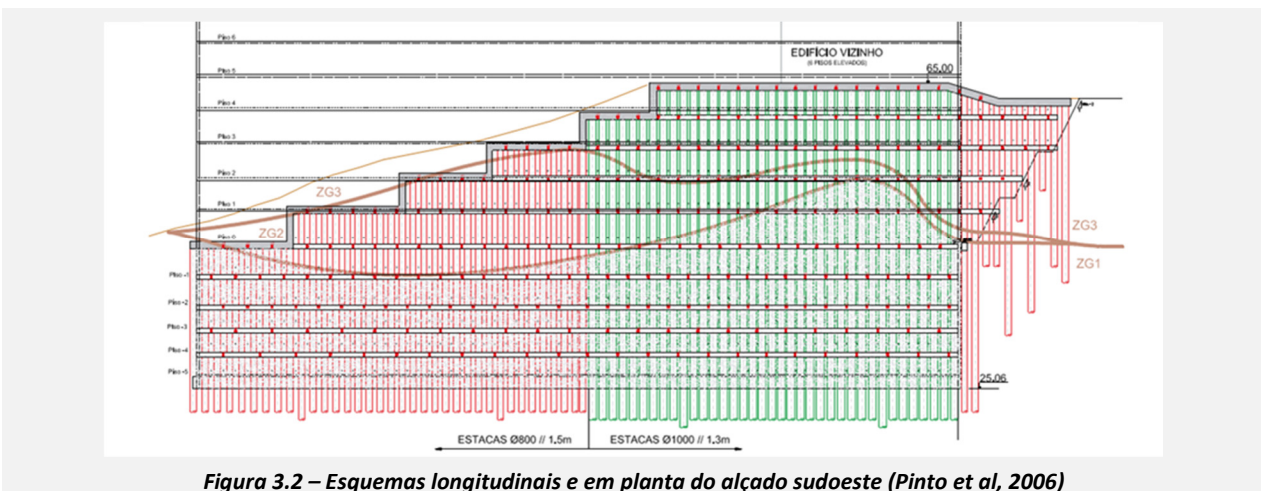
Esquemas longitudinais e em planta do alçado sudoeste (Pinto et al, 2006)
